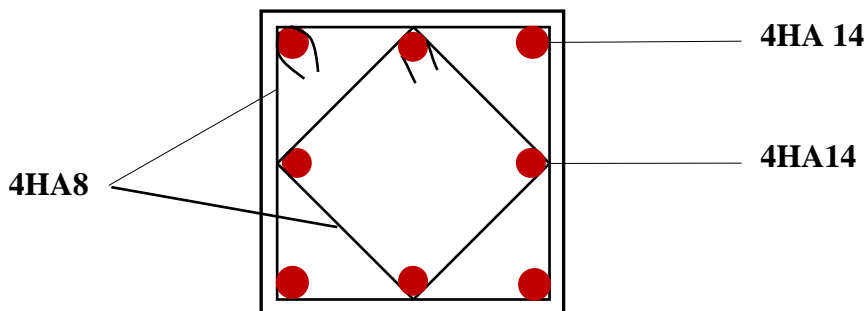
Schéma de ferraillage du poteau 35x35
